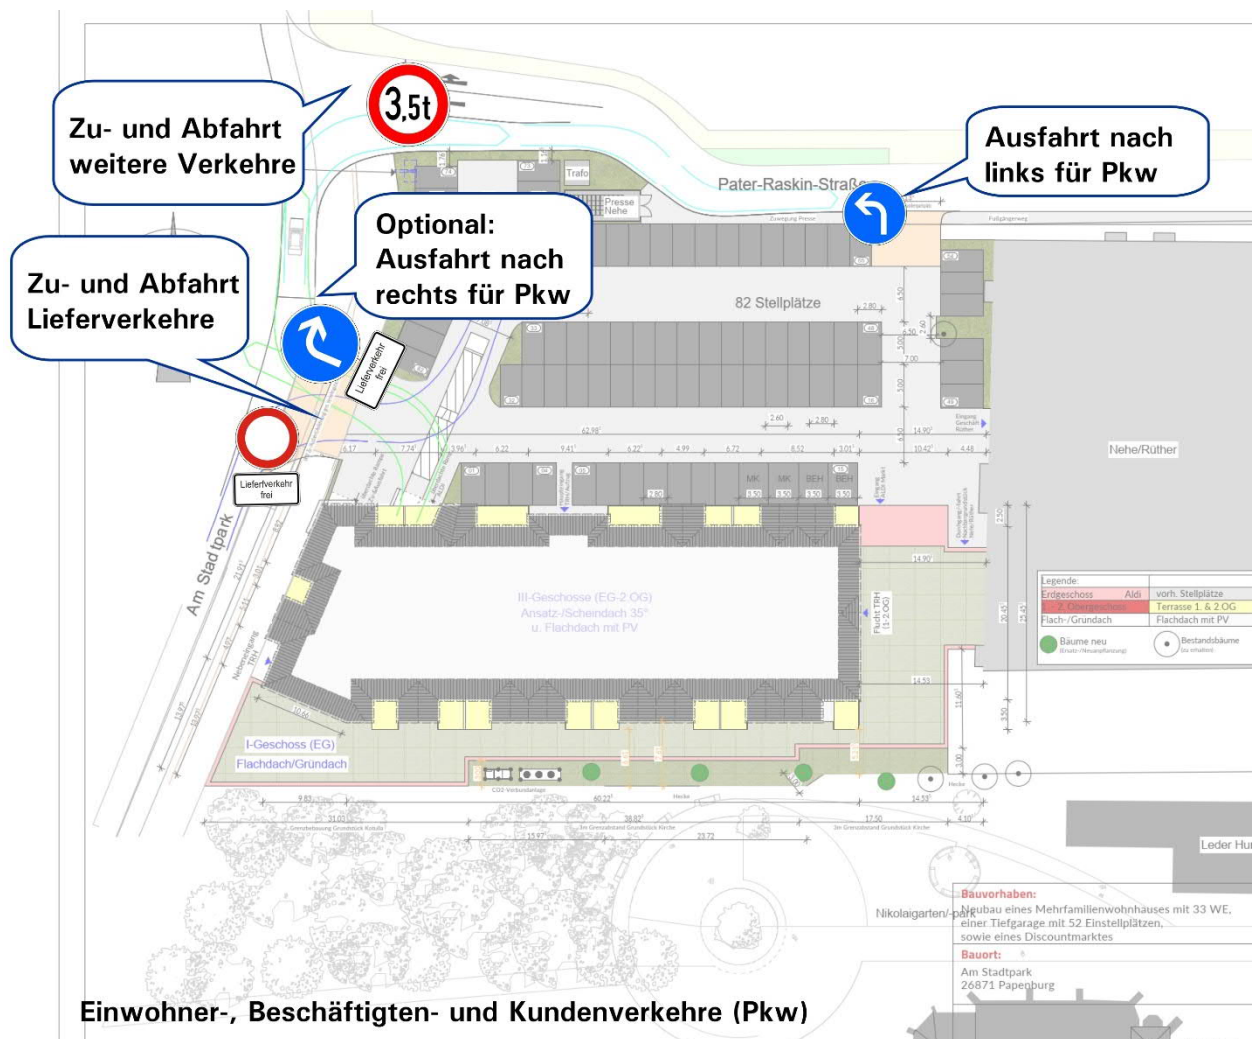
Empfohlene Maßnahmen zur Erschließung Discountermarkt und Mehrfamilienwohnen (Lageplan: Kruse Planungsbüro)
